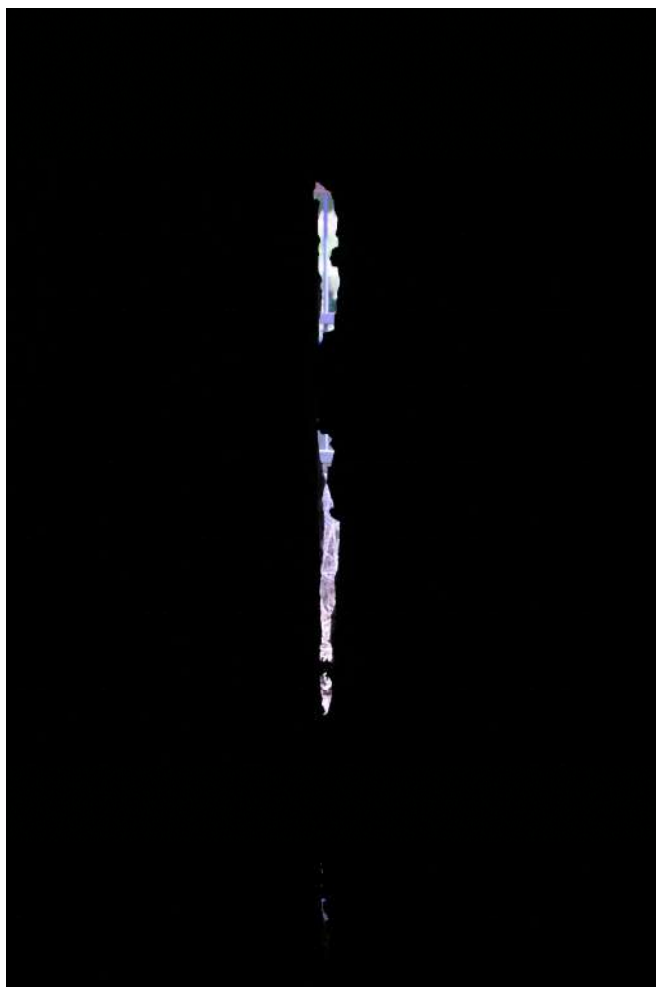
Particolare fessurazione della facciata Nord del corpo B, visto da dentro il manufatto.
